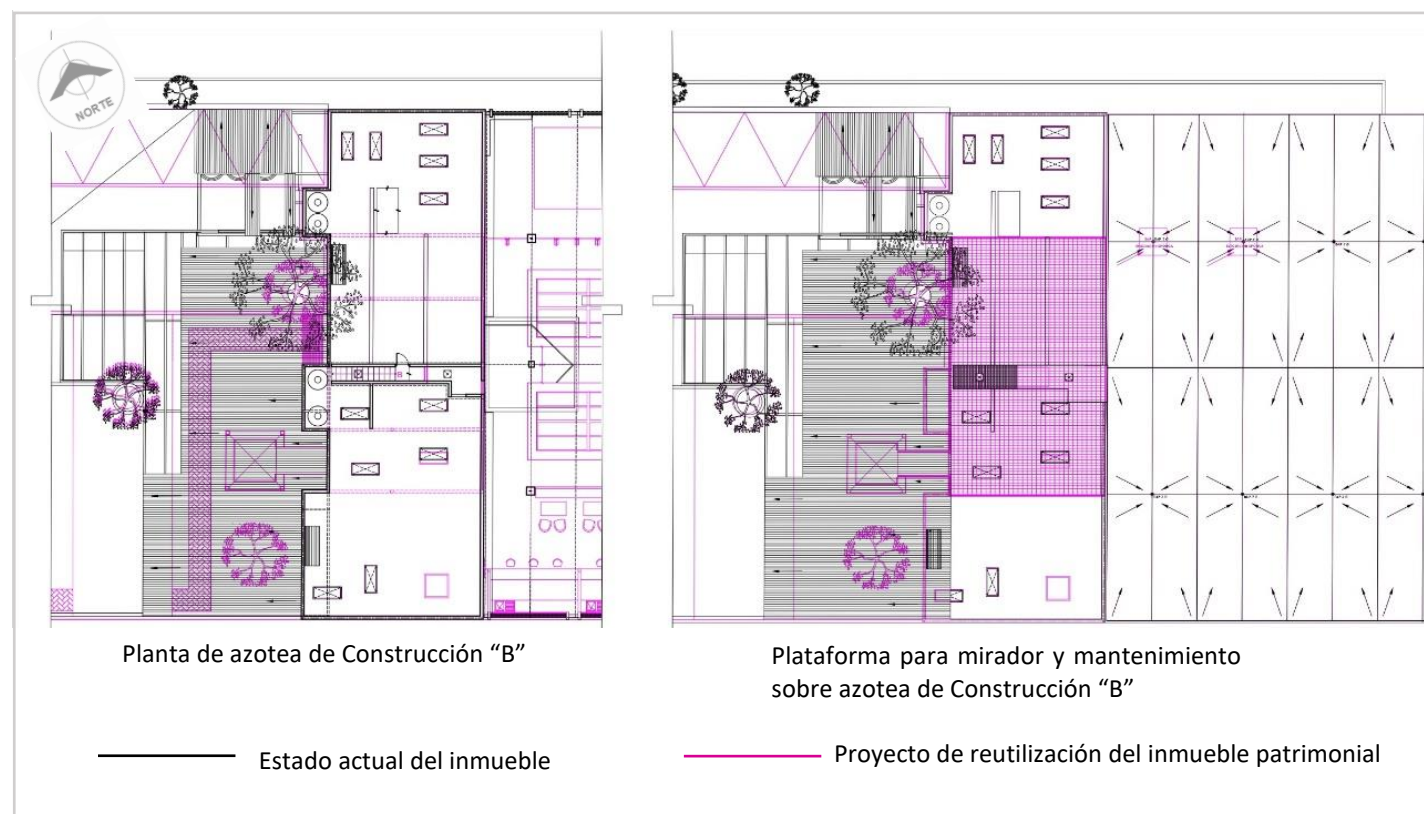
Superposición de planta de proyecto de reutilización sobre planta del estado actual del inmueble (Elaboración propia).
